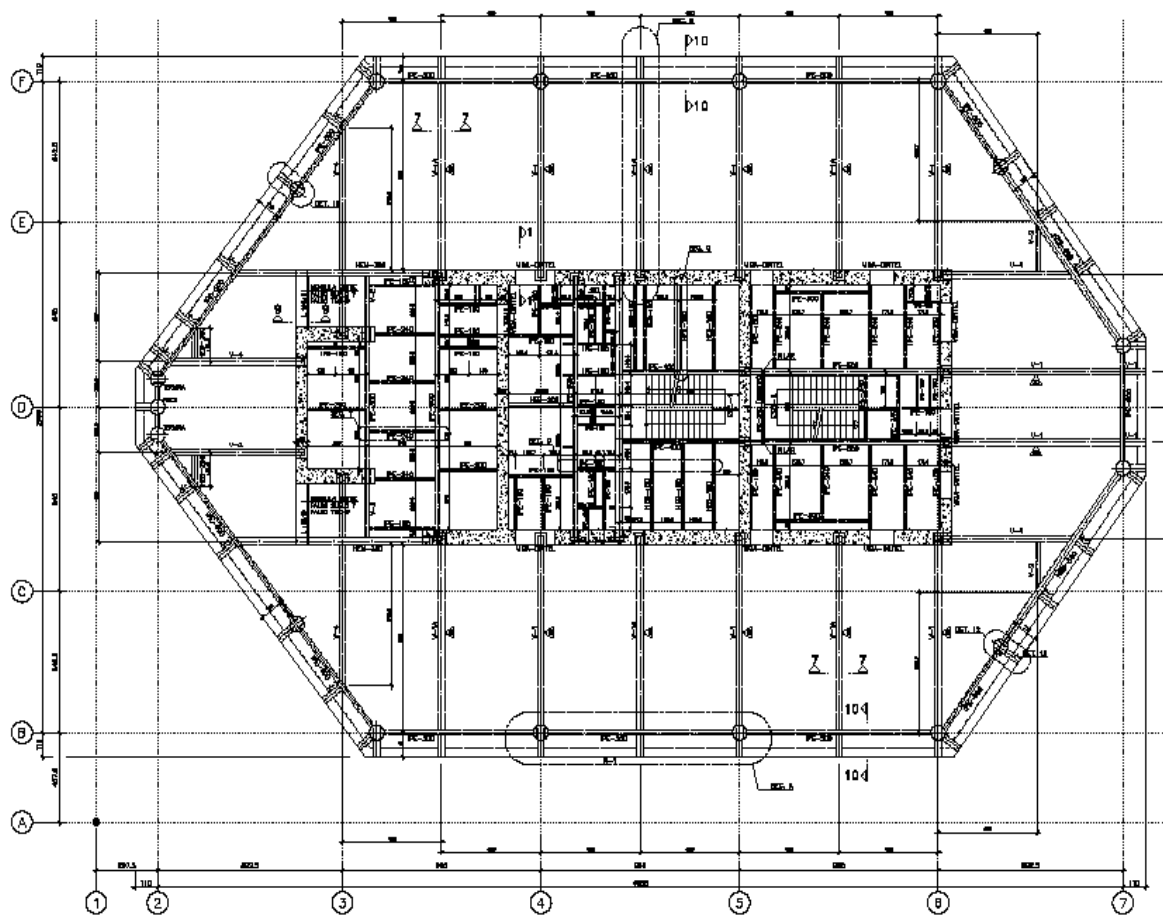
Vista in pianta di un livello generico [FHECOR]
